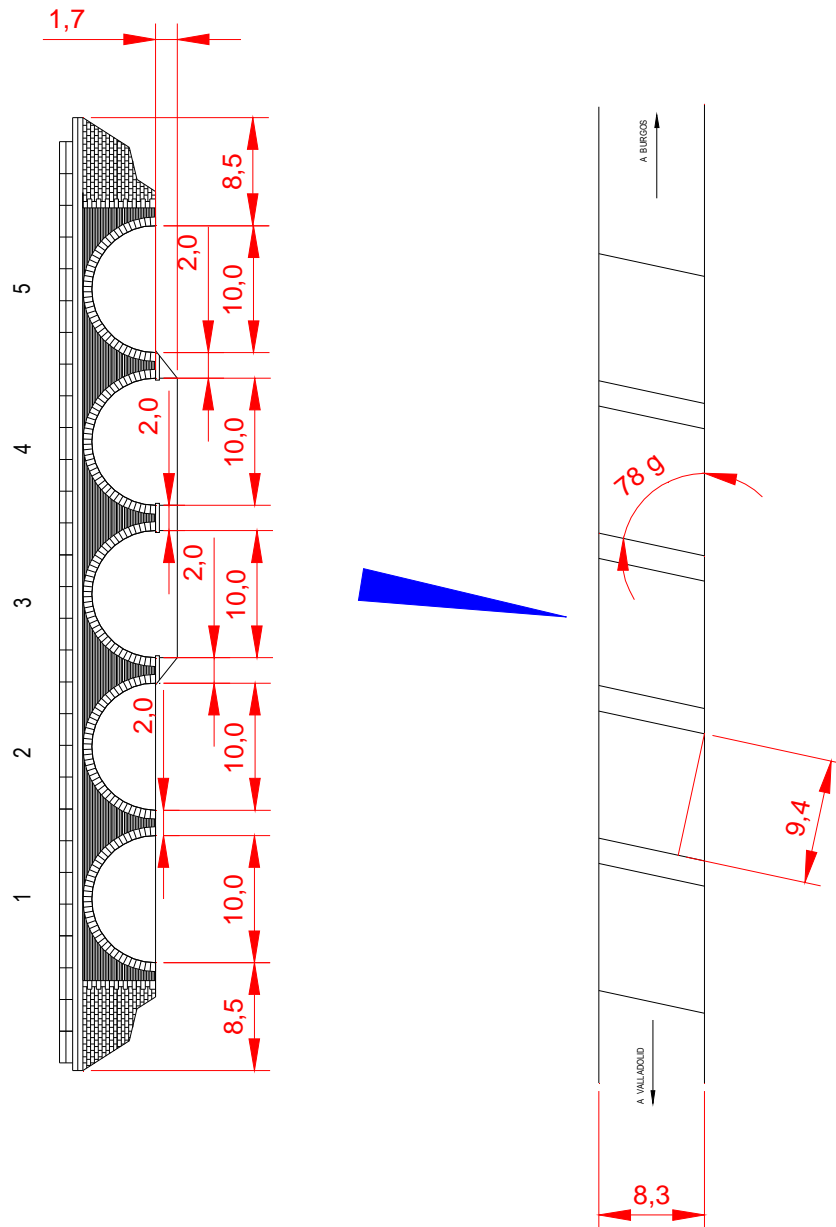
Dibujo de planta y alzado del puente del ferrocarril en Dueñas.
